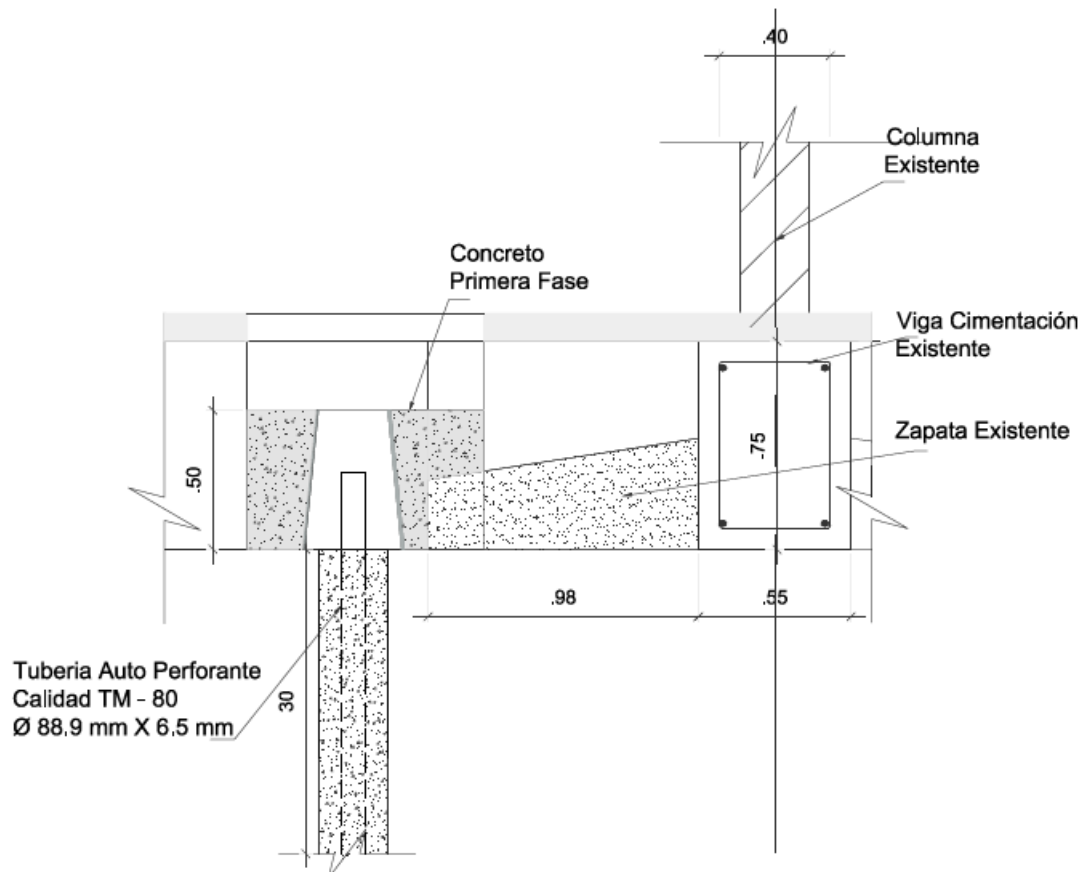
Propuesta de intervención Etapa 3 Vaciado muro de anclaje y dados, concreto primera fase – Planta (Sin escala). Fuente: Los Autores.
